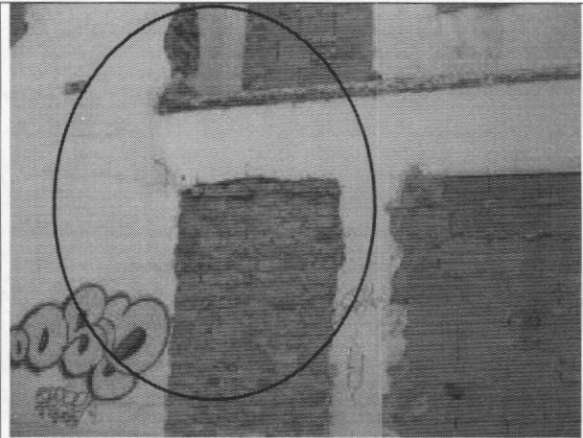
Agrietamiento y desprendimiento de unidades en muro de fachada
